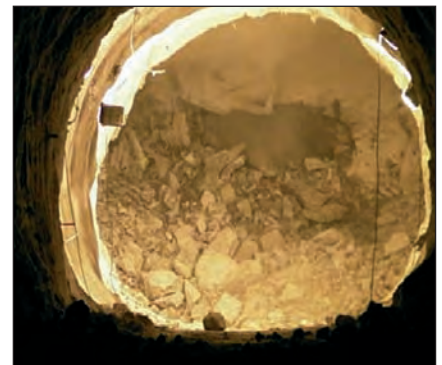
Mise au point de la congélation dans la zone de Mölleback.
